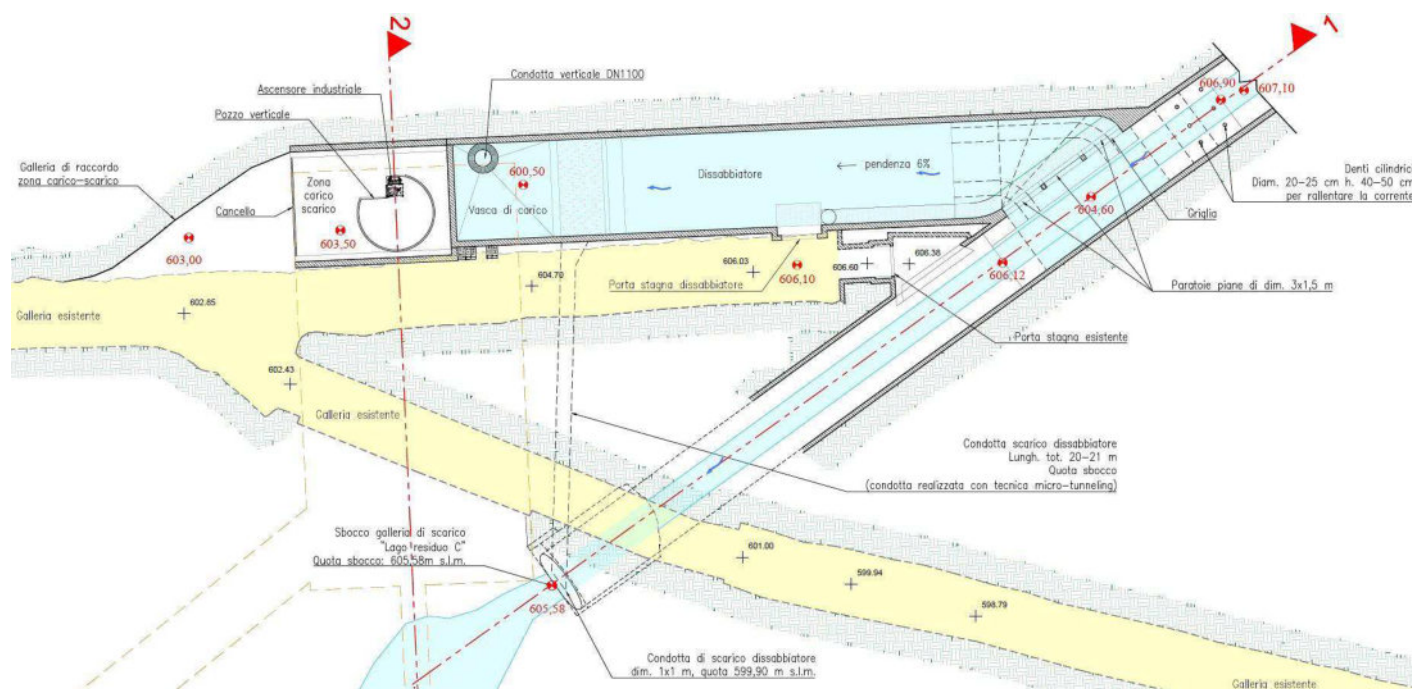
Planimetria particolareggiata dell'opera di presa: in primo piano il tratto terminale della galleria di sorpasso e l'opera di captazione dell'impianto in progetto.
